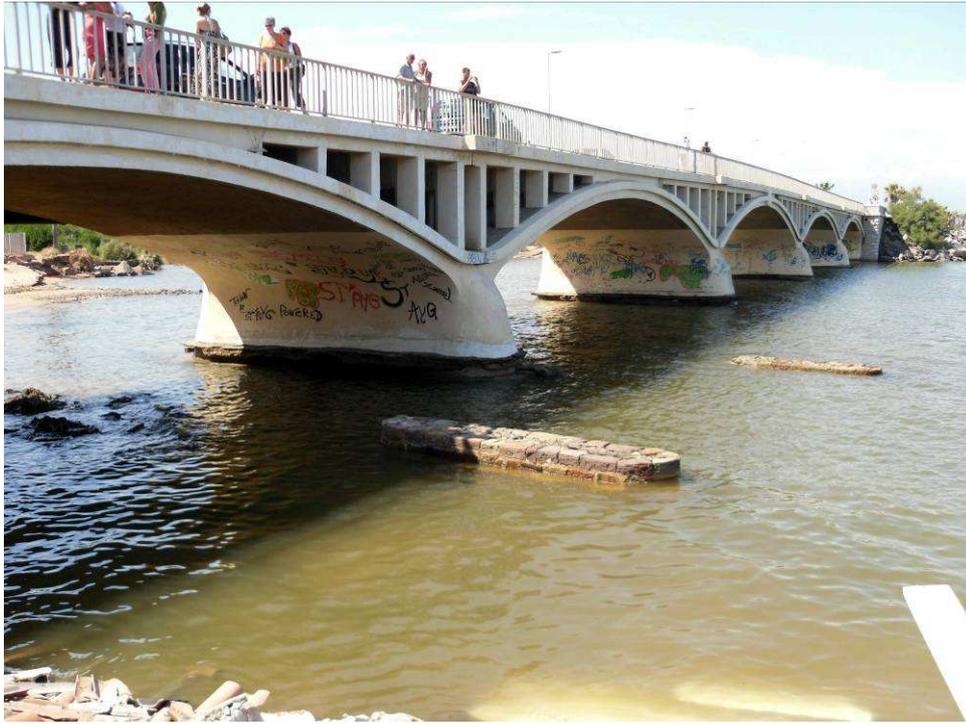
Juillet 2010 - Cinq arches en eau après la crue (photo DDTM)
